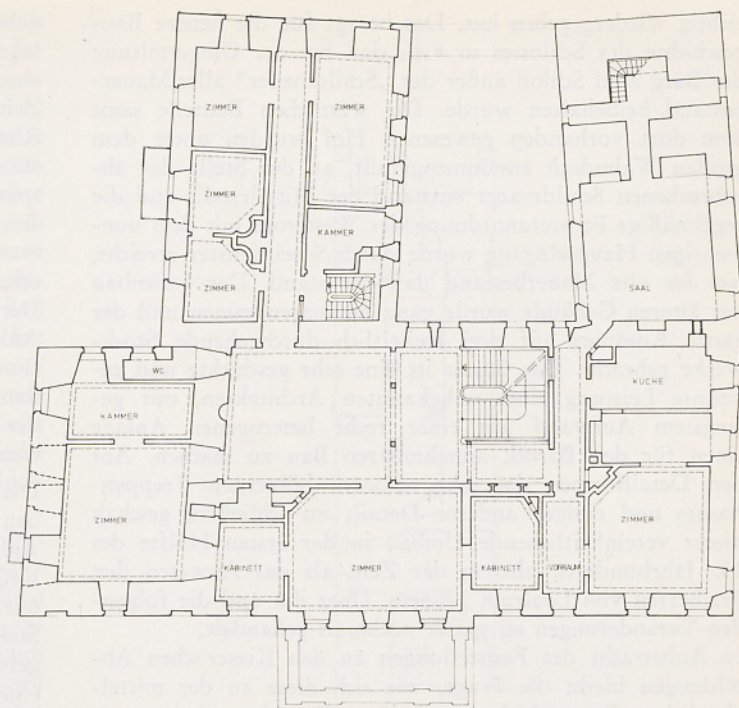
Grundriß des Zustandes im Jahr 1973. Obergeschoß
